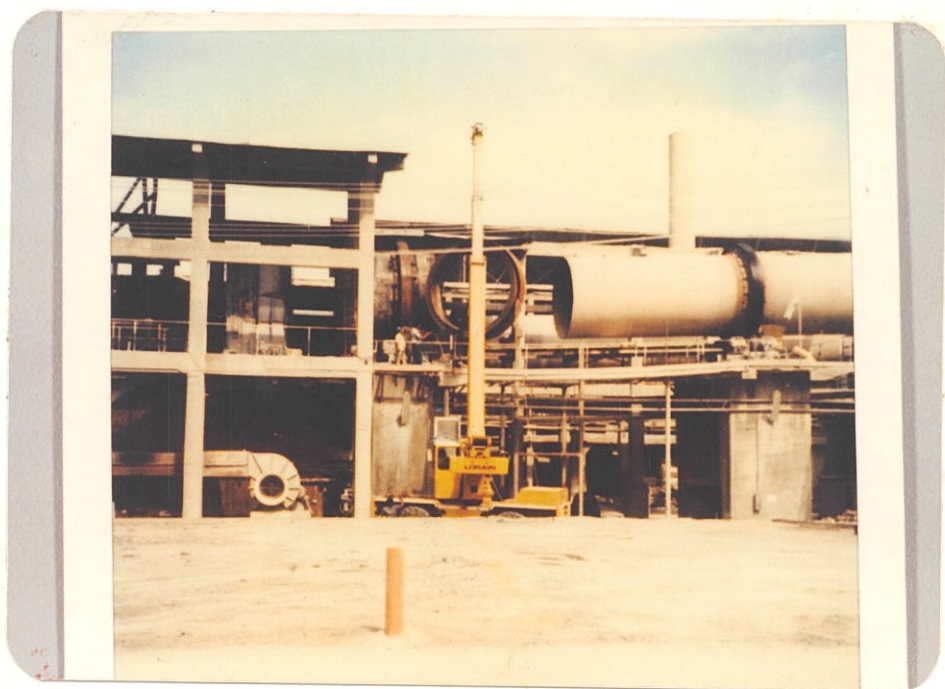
MONTAJE ZONA DE SOPORTE DE SEGMENTOS DE
